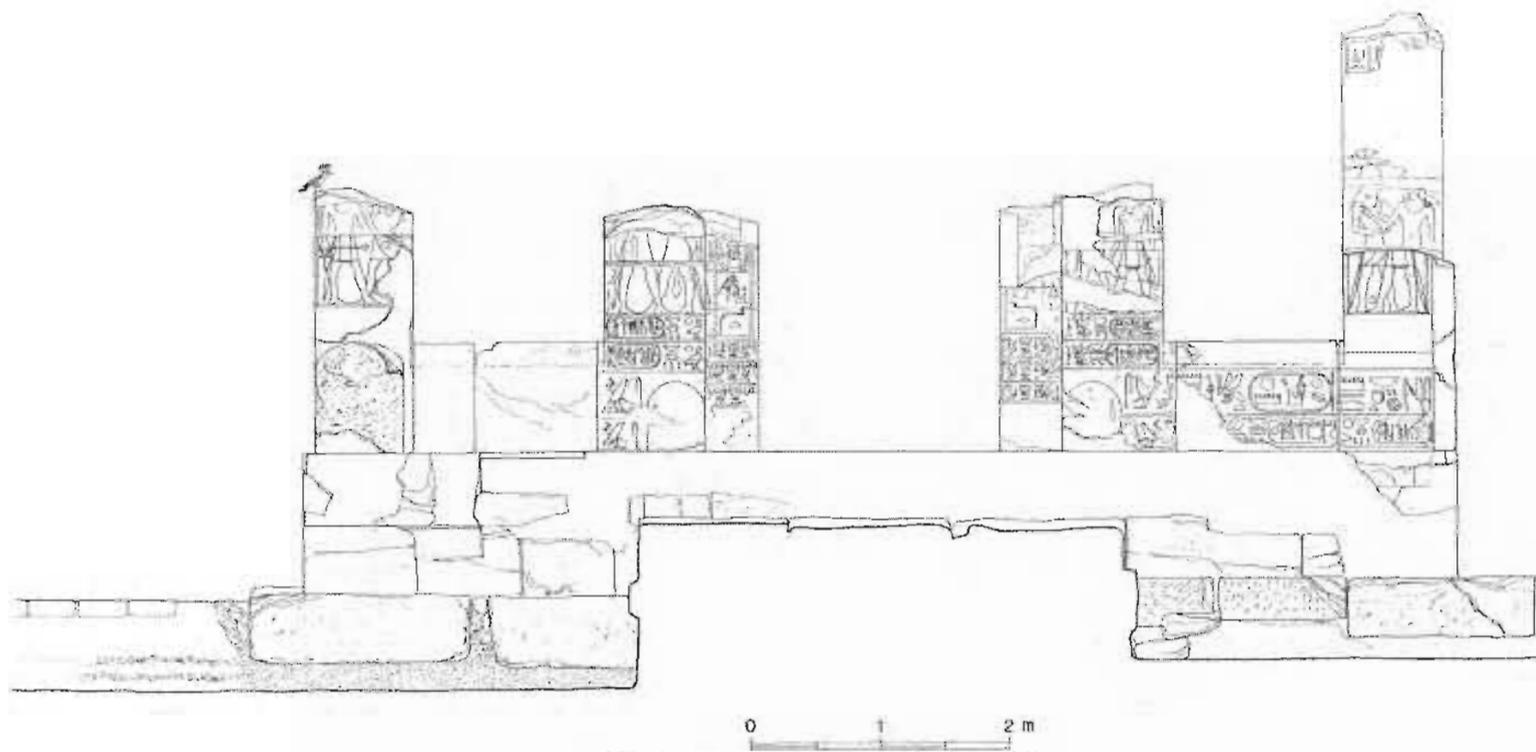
Élévation de la façade méridionale avec coupe sur la rampe, AA'.
